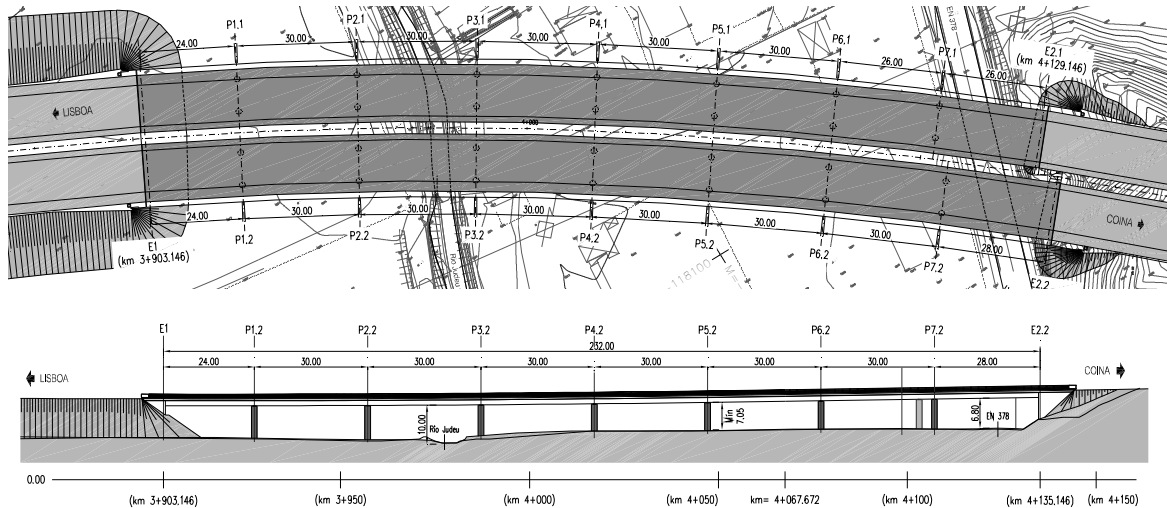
Viaduto das Laranjeiras: Planta e alçado
